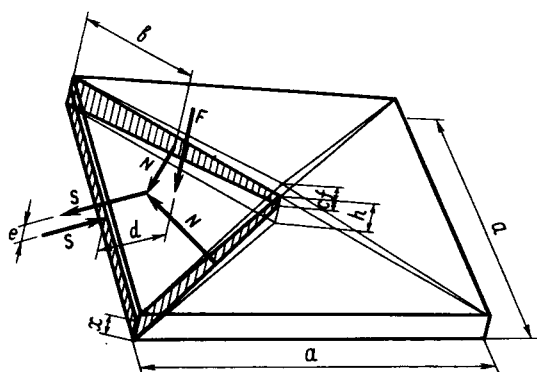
Расчетная схема разрушения монолитной плиты без арматуры
